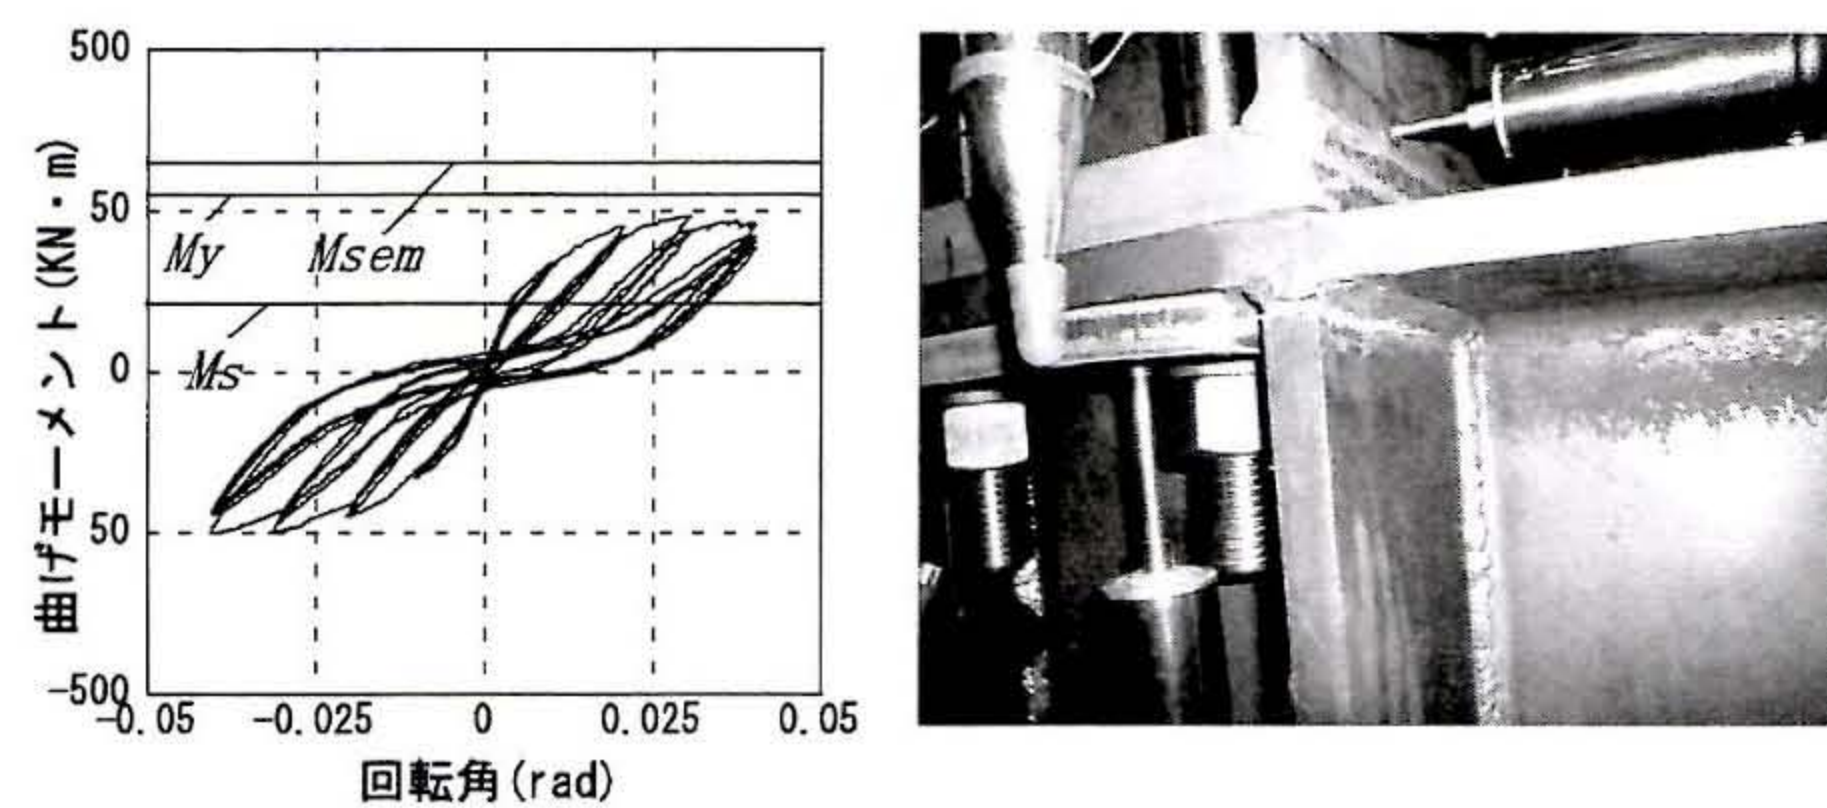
実験結果 試験体 No. 1 写真1 溶接部破断状況
